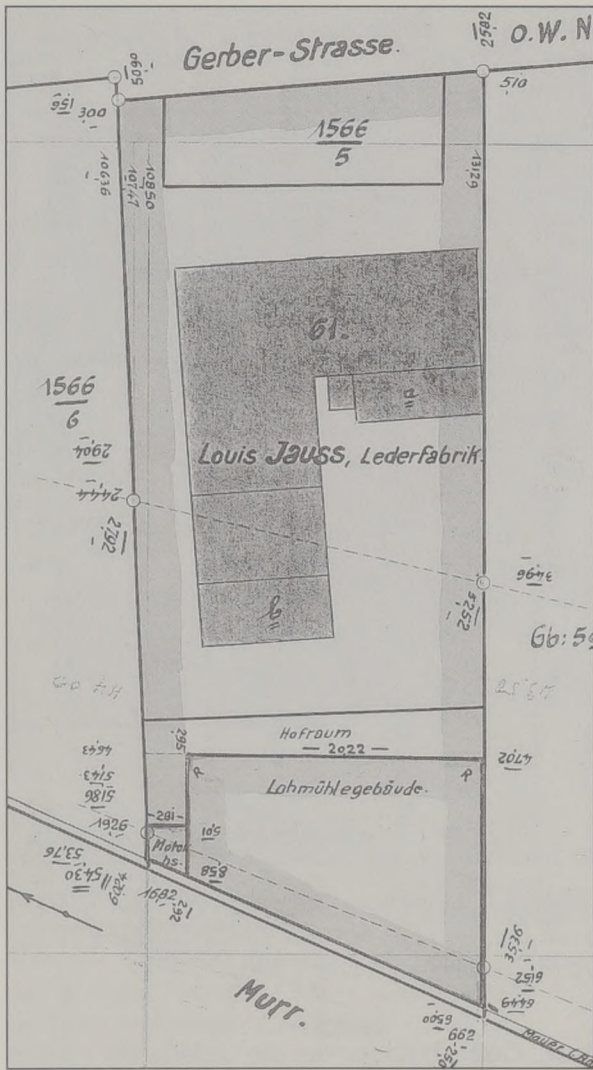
Lageplan mit den auf der Parzelle 1566/4 (Gerberstraße 61) bis 1910 errichteten Gebäuden.
